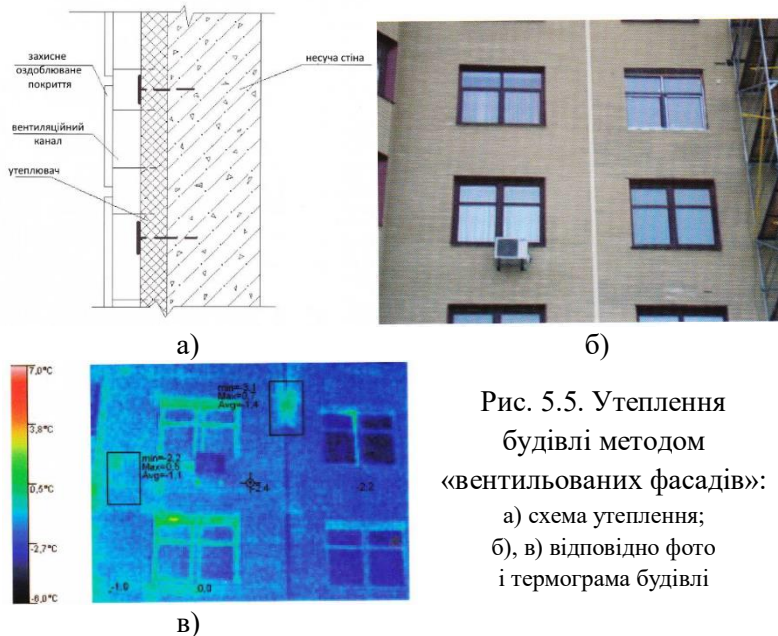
Утеплення будівлі методом «вентилюваних фасадів»:
